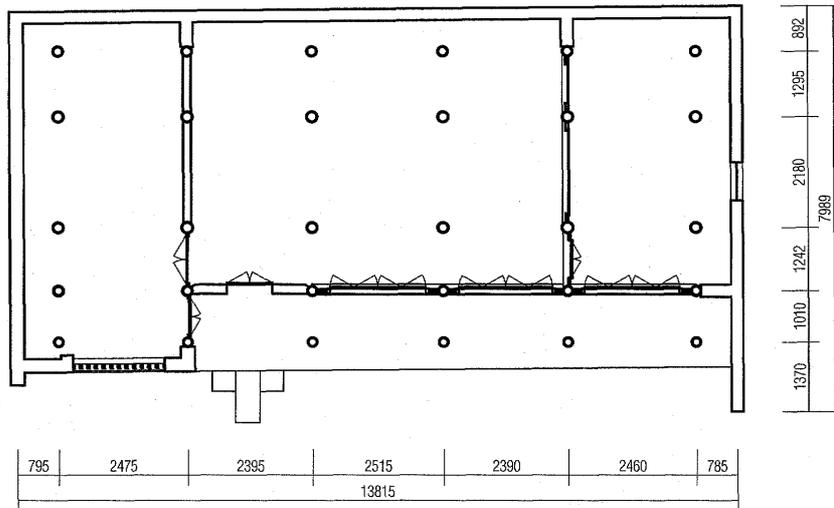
Nguyen Tien Dong邸 主屋 平面図 1:150
